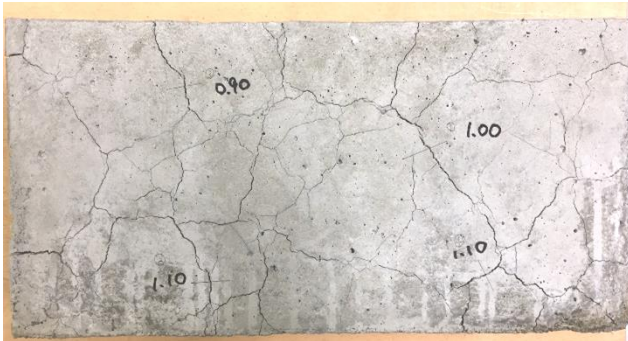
模擬 ASR 供試体ひび割れ様子
